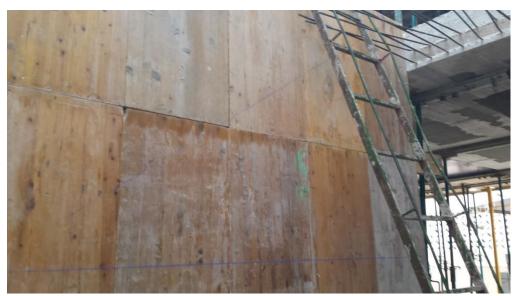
Replanteo de la escalera en el encofrado vertical colocado
